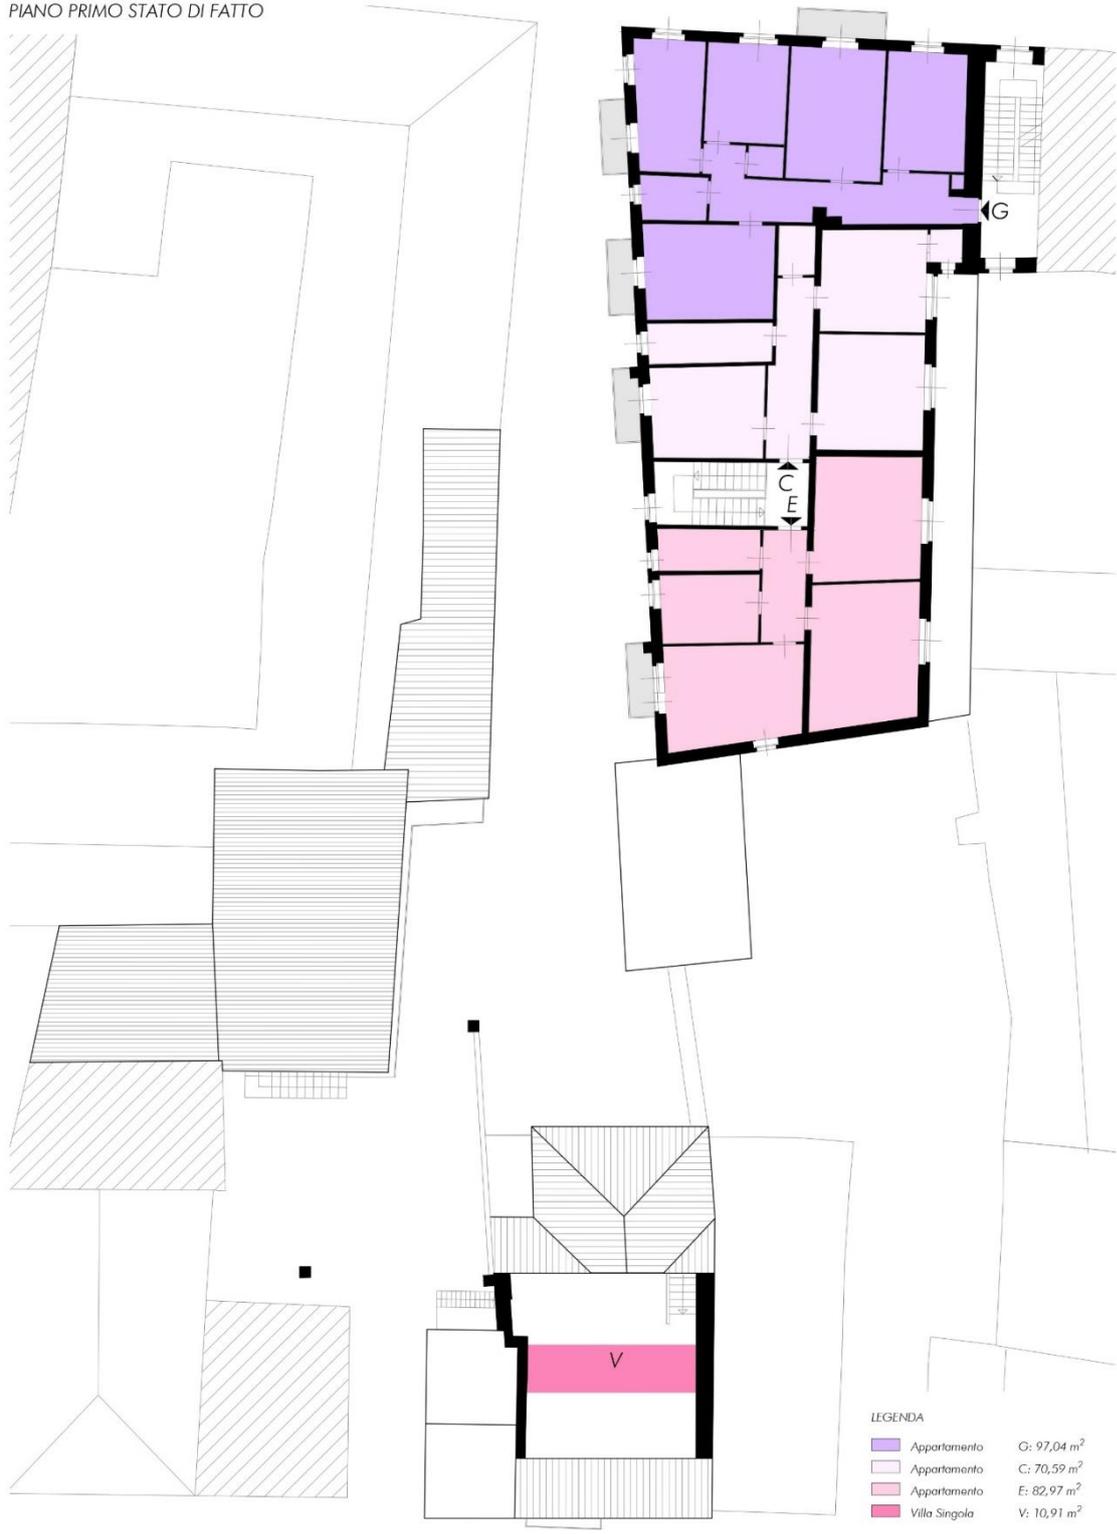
Suddivisione spazi funzionali all'interno del complesso condominiale Stato di Fatto
